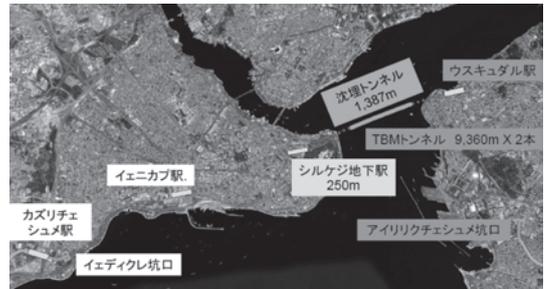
ボスポラス海峡横断鉄道建設 平面ルート図
